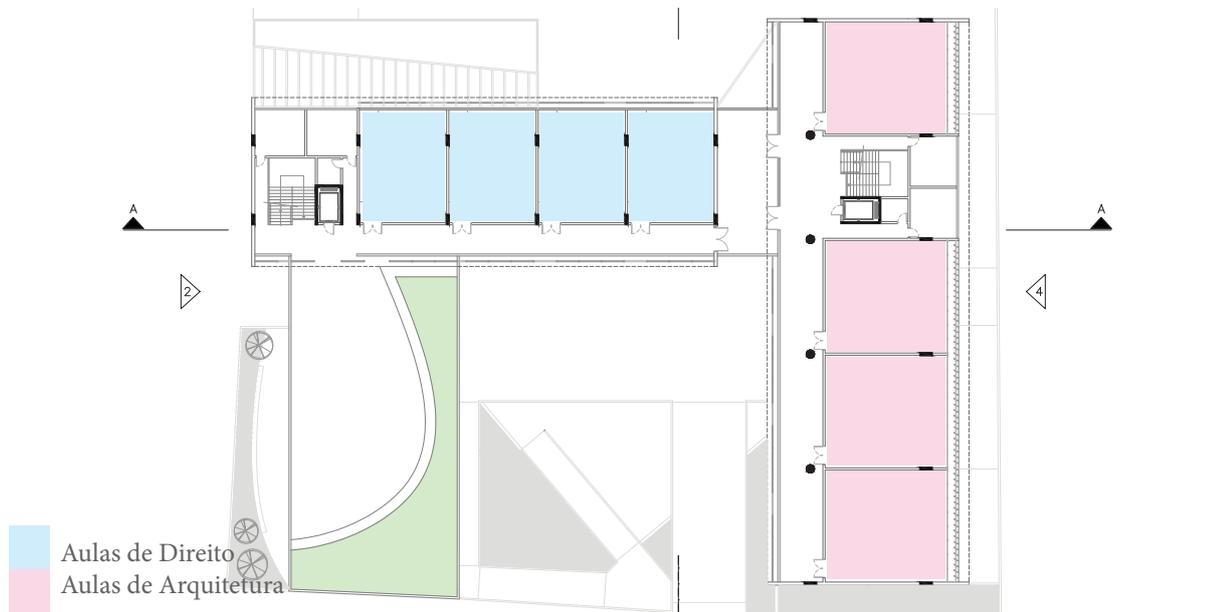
Situação anterior do primeiro pavimento de Salas de Aula de Direito e Arquitetura
